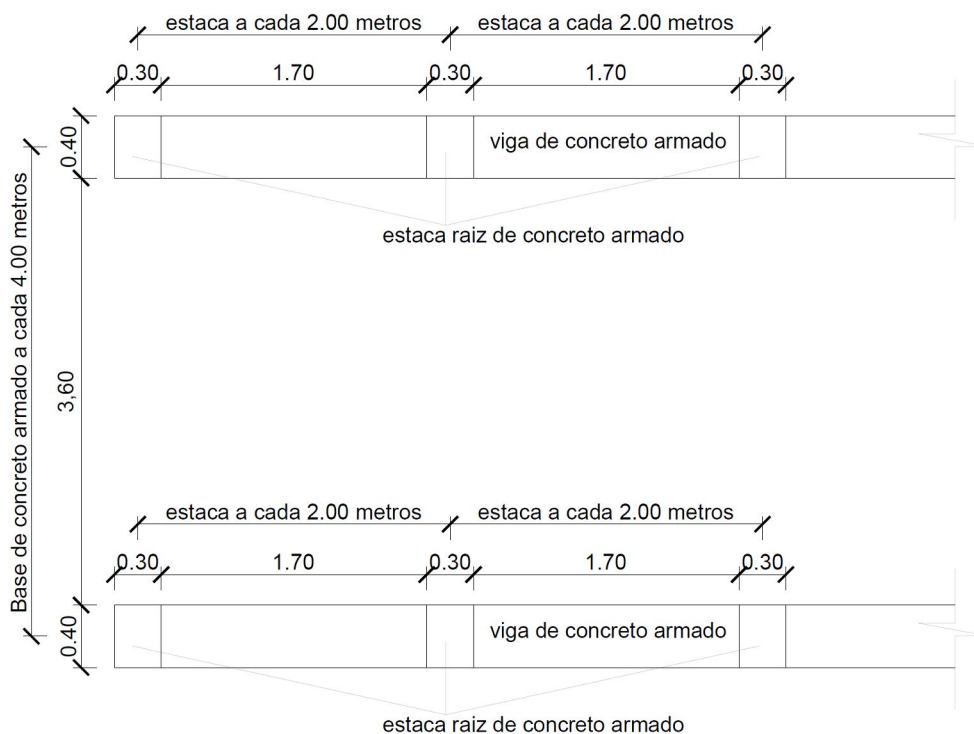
Detalhamento do bloco de assentamento das escolas em planta baixa
